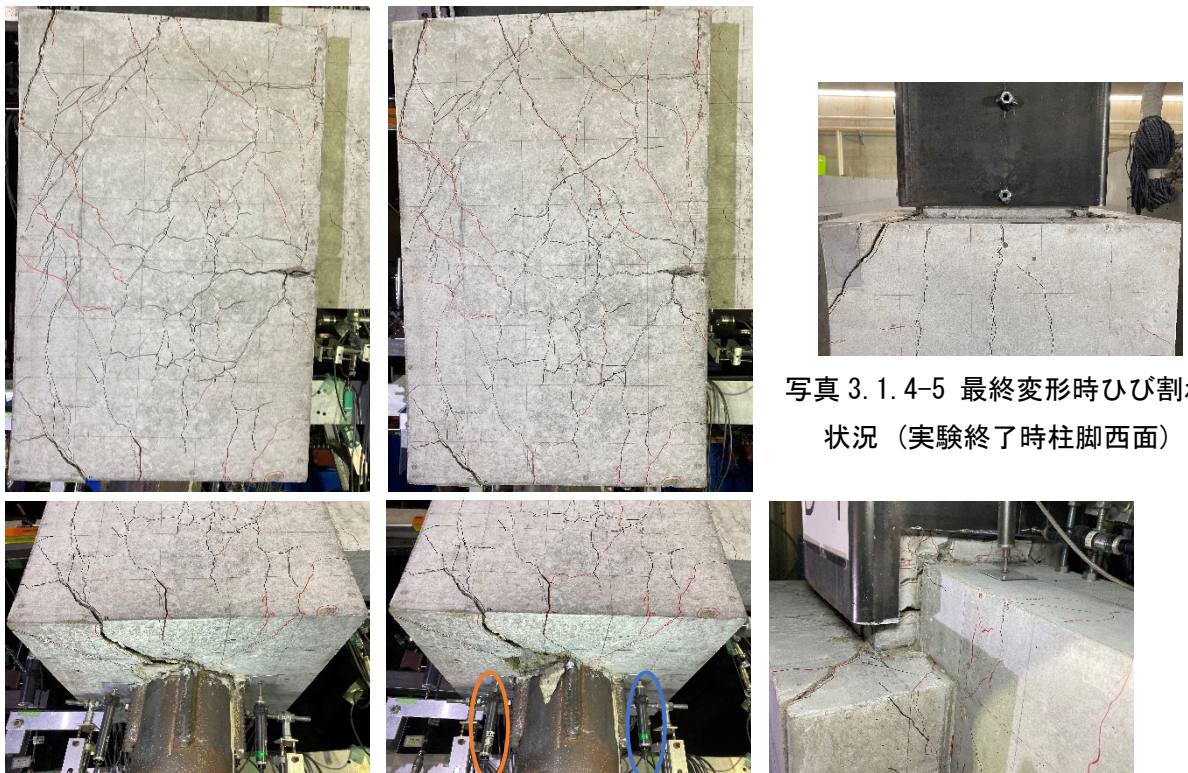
1. 4-5 最終変形時ひび割れ状況（実験終了時柱脚西面）
